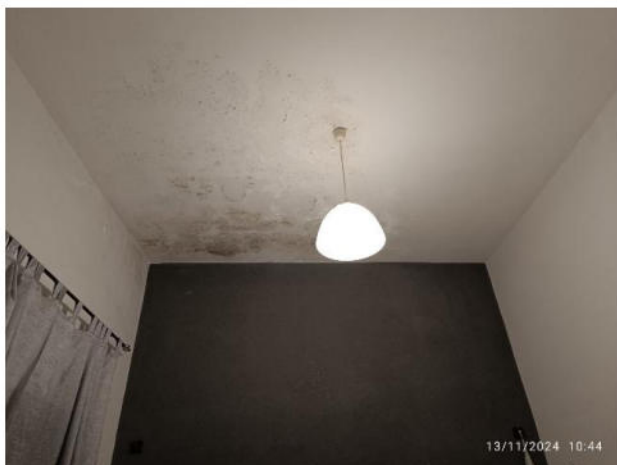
Macchie di umidità discendente nelle camere 6 e 4 dovute a guasti nell'impermeabilizzazione di copertura
